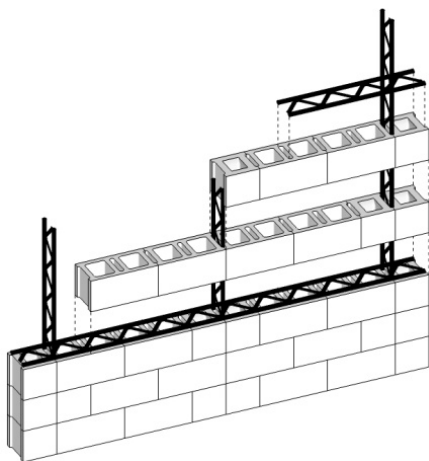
Parede com blocos de betão e a armadura treliçada
